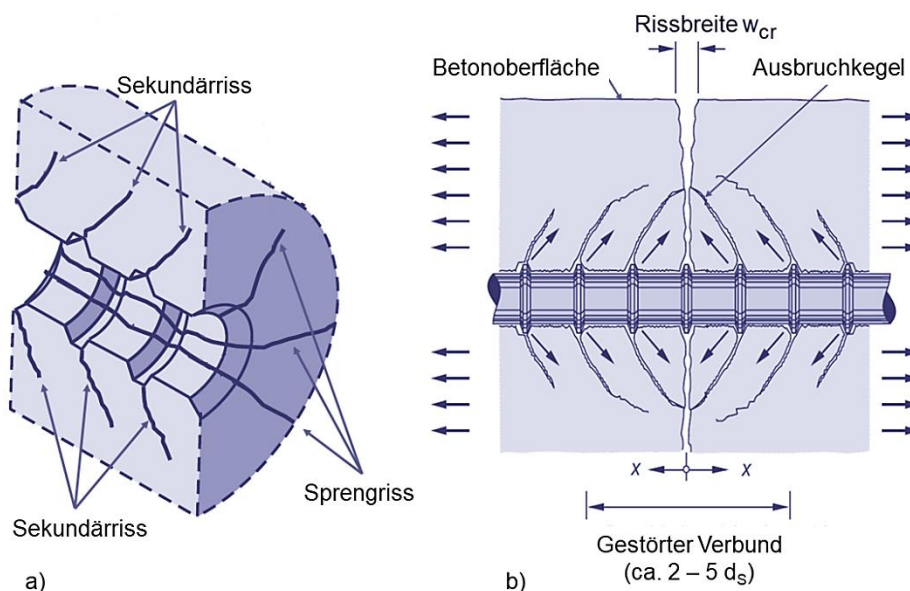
Verbundrisse und Verbundstörung im Beton.
